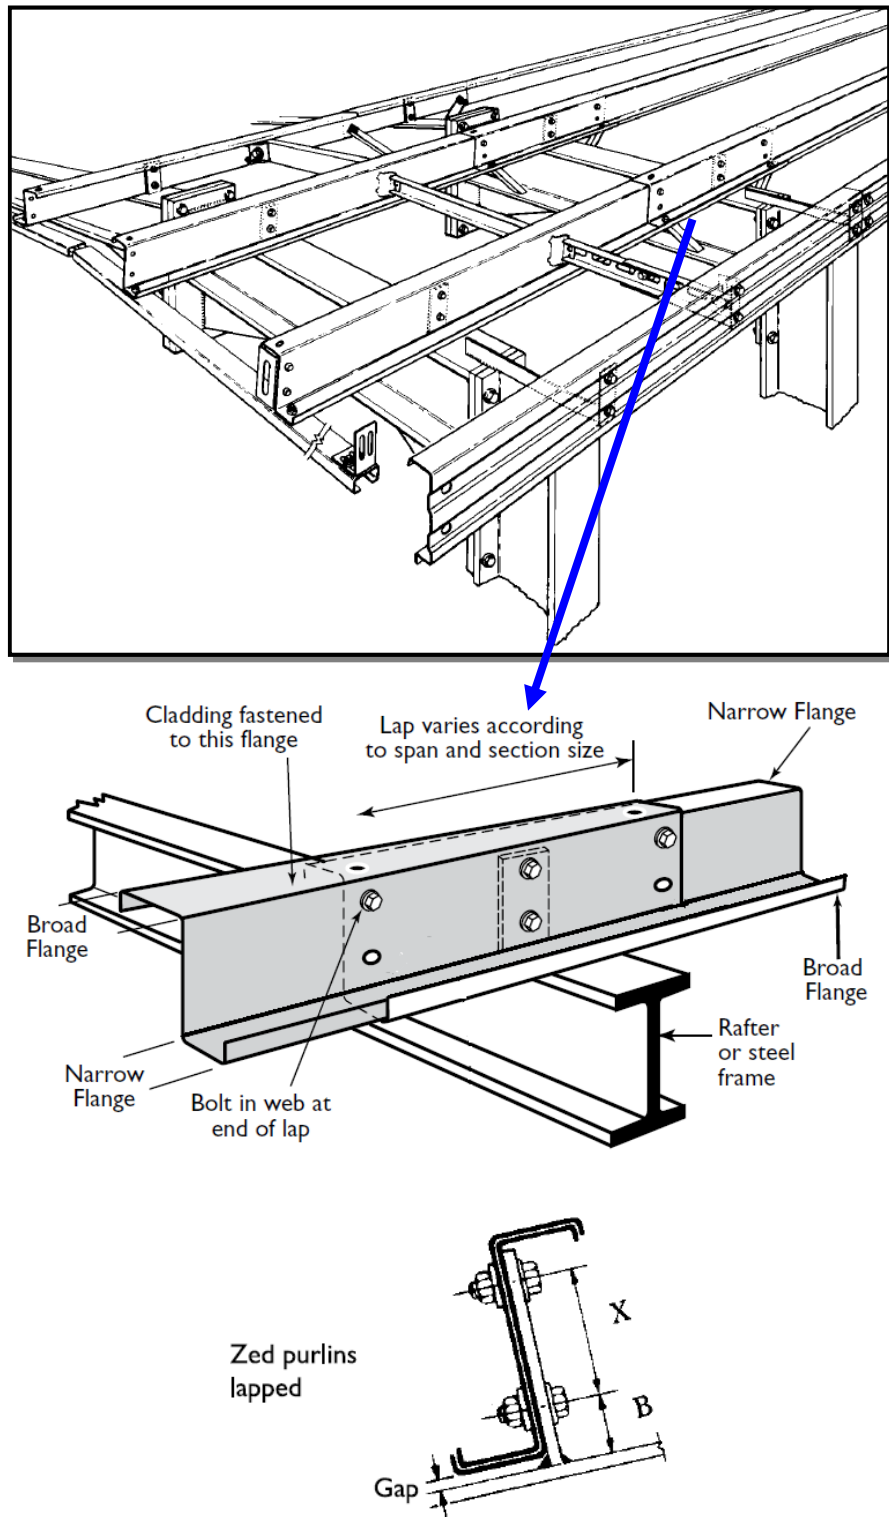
Dettagli sul collegamento overlap: telaio, zoom sulla zona di overlap e sezione.
